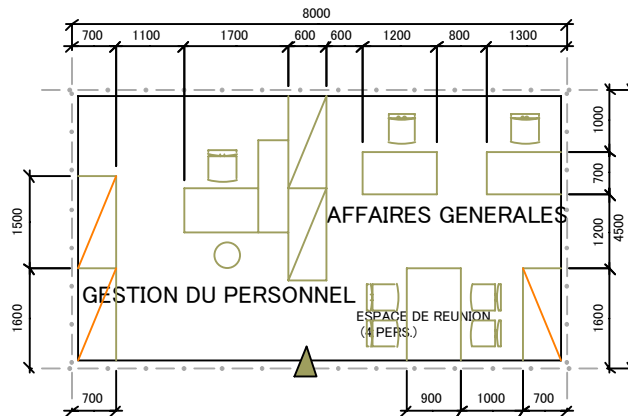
Plan planimétrique du bureau de gestion du personnel/affaires générales
